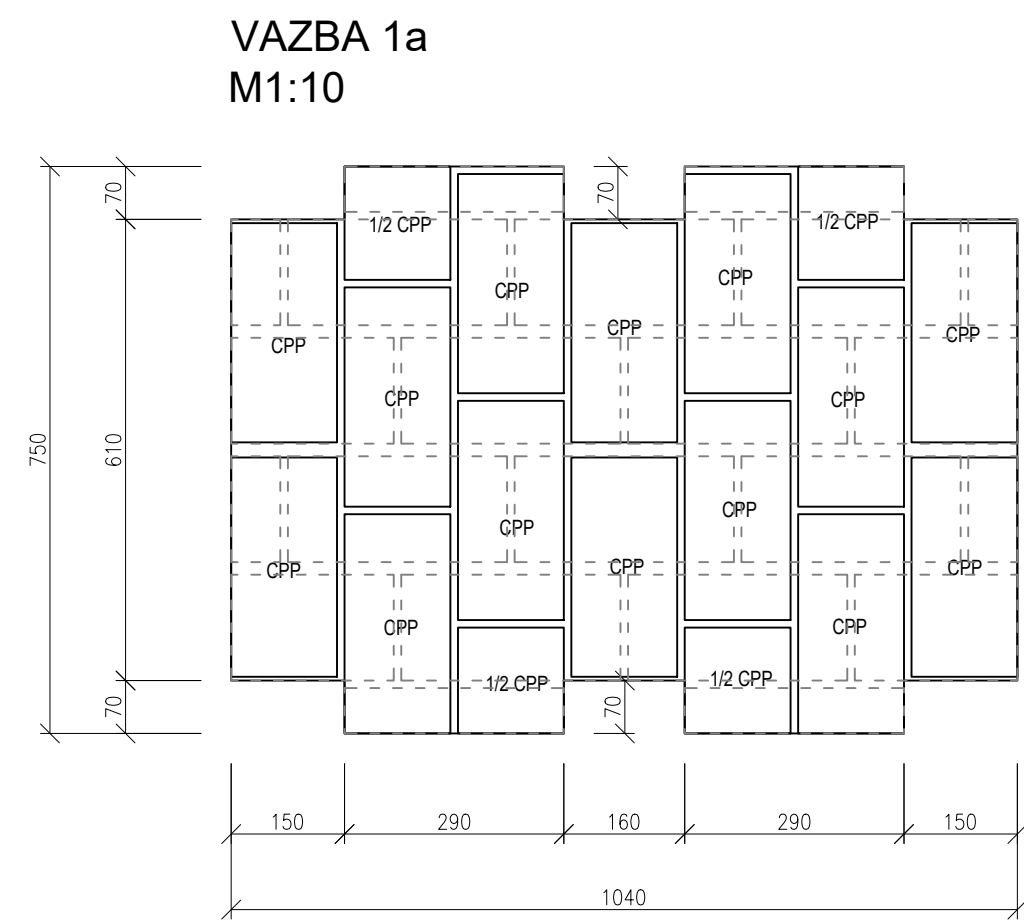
DETAIL B - NOVÝ ZDĚNÝ PILÍŘ
